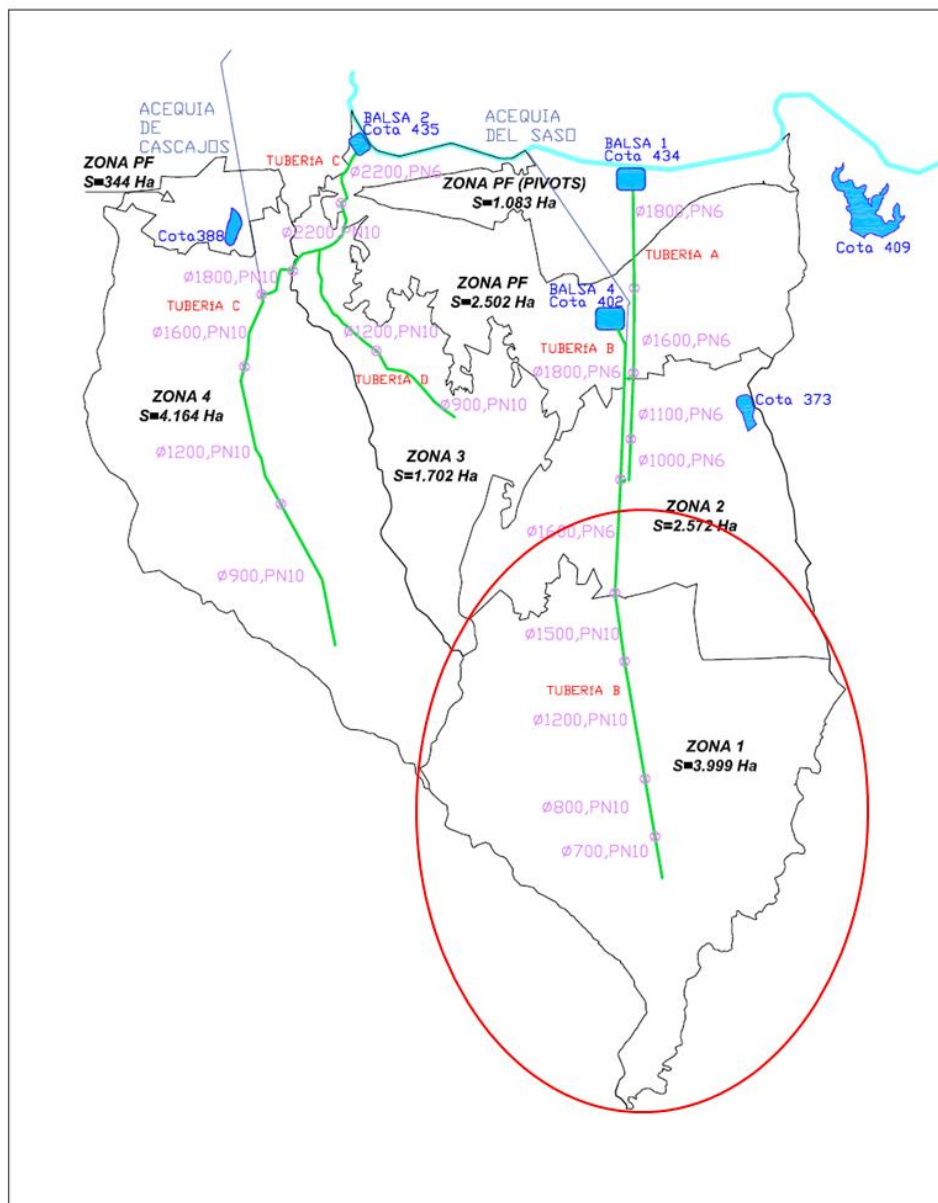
Alternativa 1 (alternativa 1.6 del Plan Director). En rojo se señala la zona que se considera en este proyecto.
